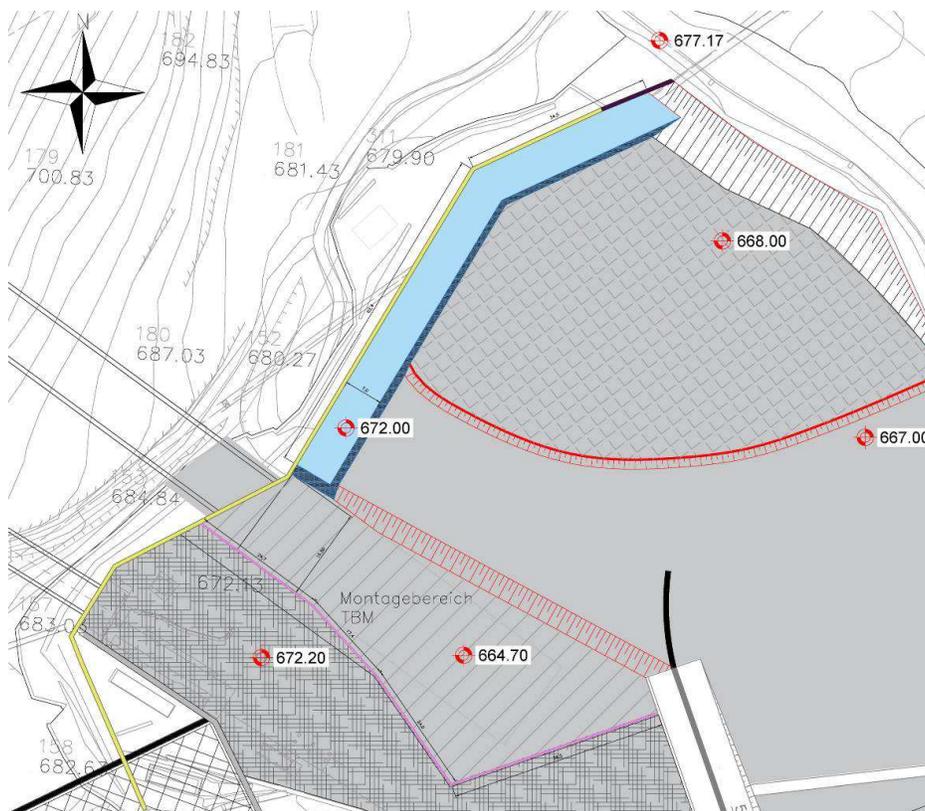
Estratto planimetria area di cantiere (dall'elaborato grafico n. PRV_C3A_7582)
